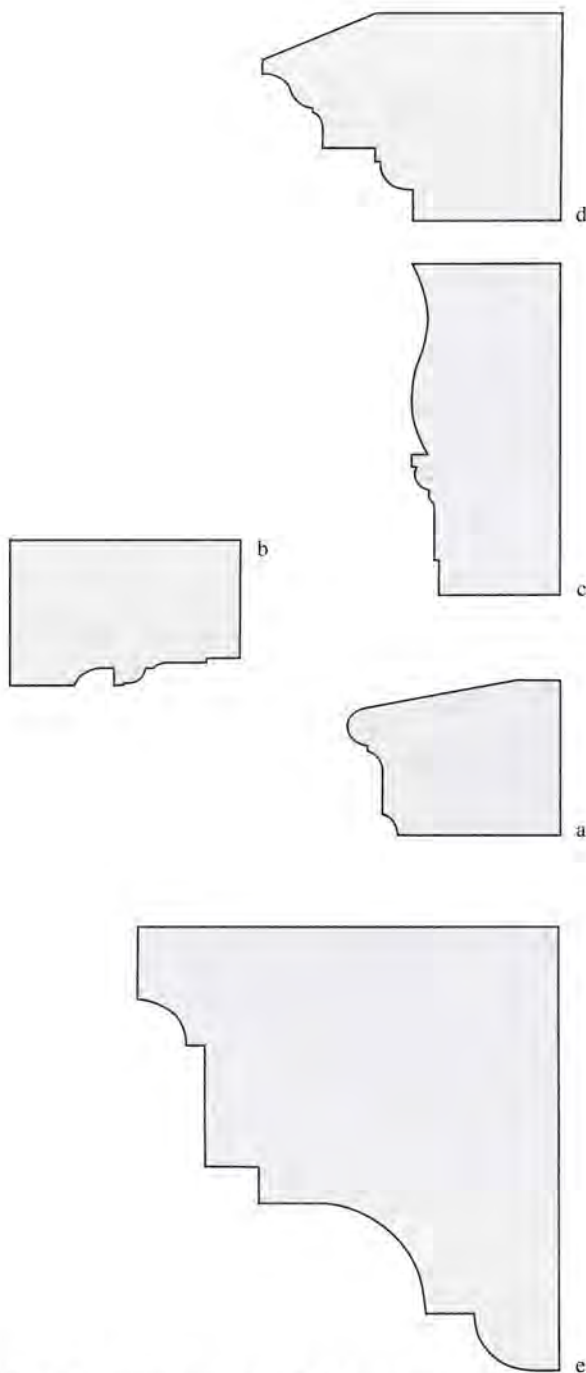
Nordwestflügel, Erker 1632, Aufnahmepläne 1980. a. Profil Fensterbank. b. Profil Fenstergewände, c. Profil Fenstersturz. d. Profil Fensterverdachung. e. Profil Konsolen. M 1:10.
